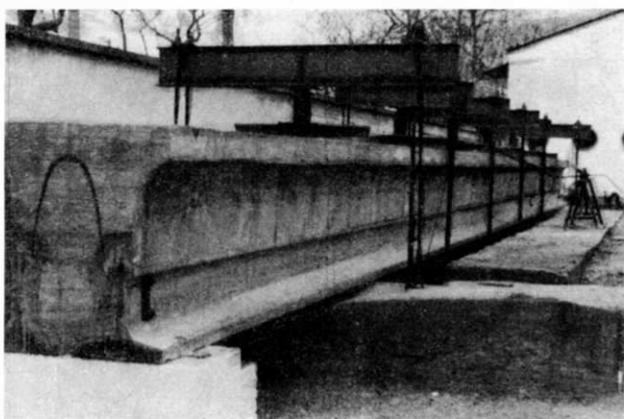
Vista dell'impalcato sperimentale con T.A.S. profilo 52.
